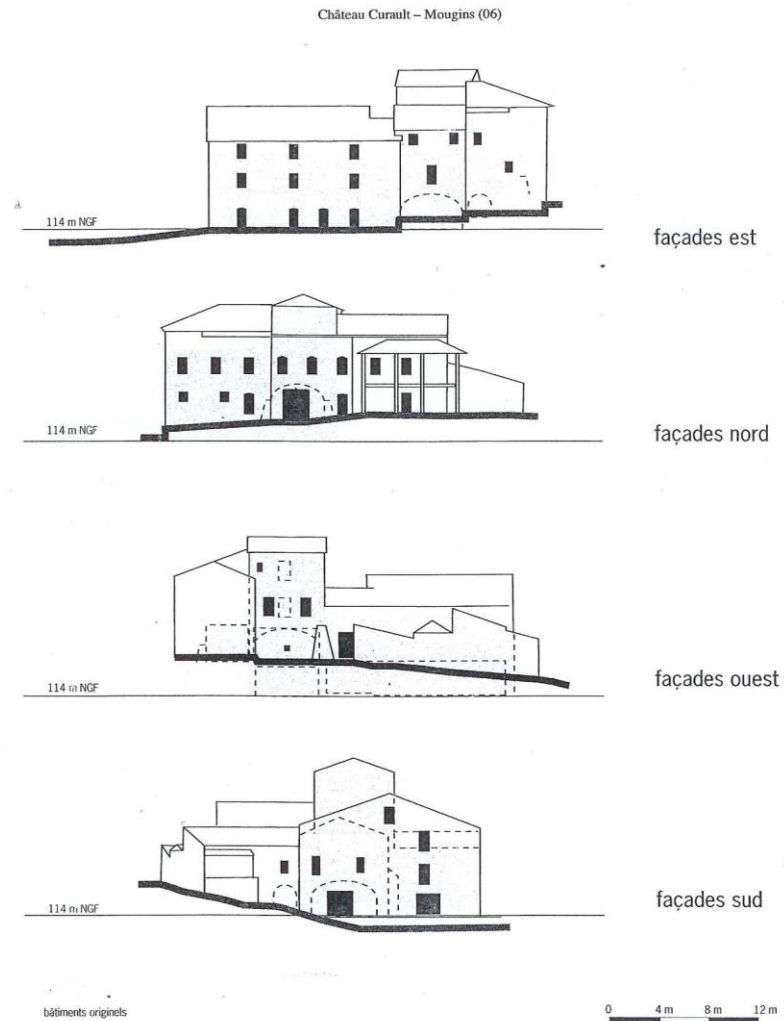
Planche façades (Topo B. Fabry, DAO R. Thernot).
